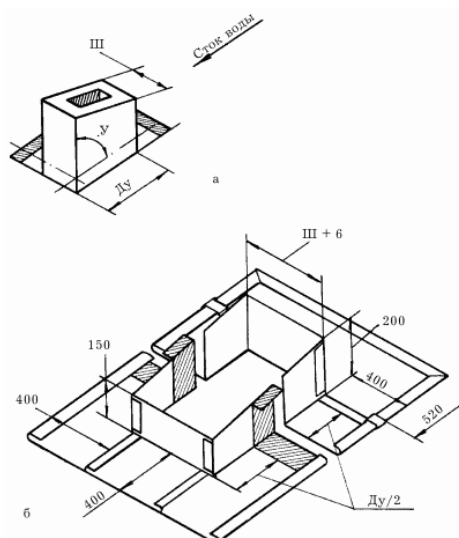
Заготовление воротника дымовой трубы: а – общий вид дымовой трубы; б – детали воротника, подготовленные к укладке;  $D_u$  – длина дымовой трубы по уклону;  $\Pi$  – ширина дымовой трубы;  $У$  – угол между стенкой трубы и скатом крыши.
